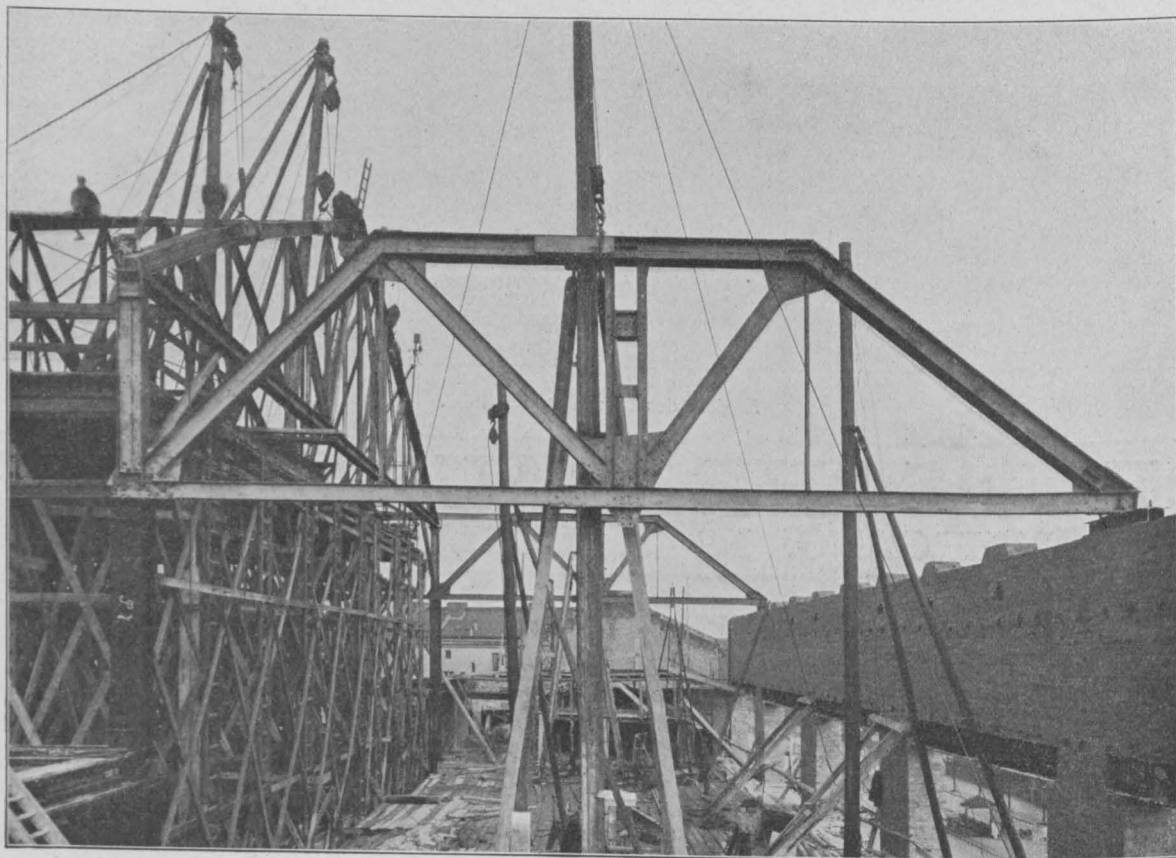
Trapezförmige Fachwerk-Unterzüge im abgewalmten Teil des Daches des Zuschauerhauses.
